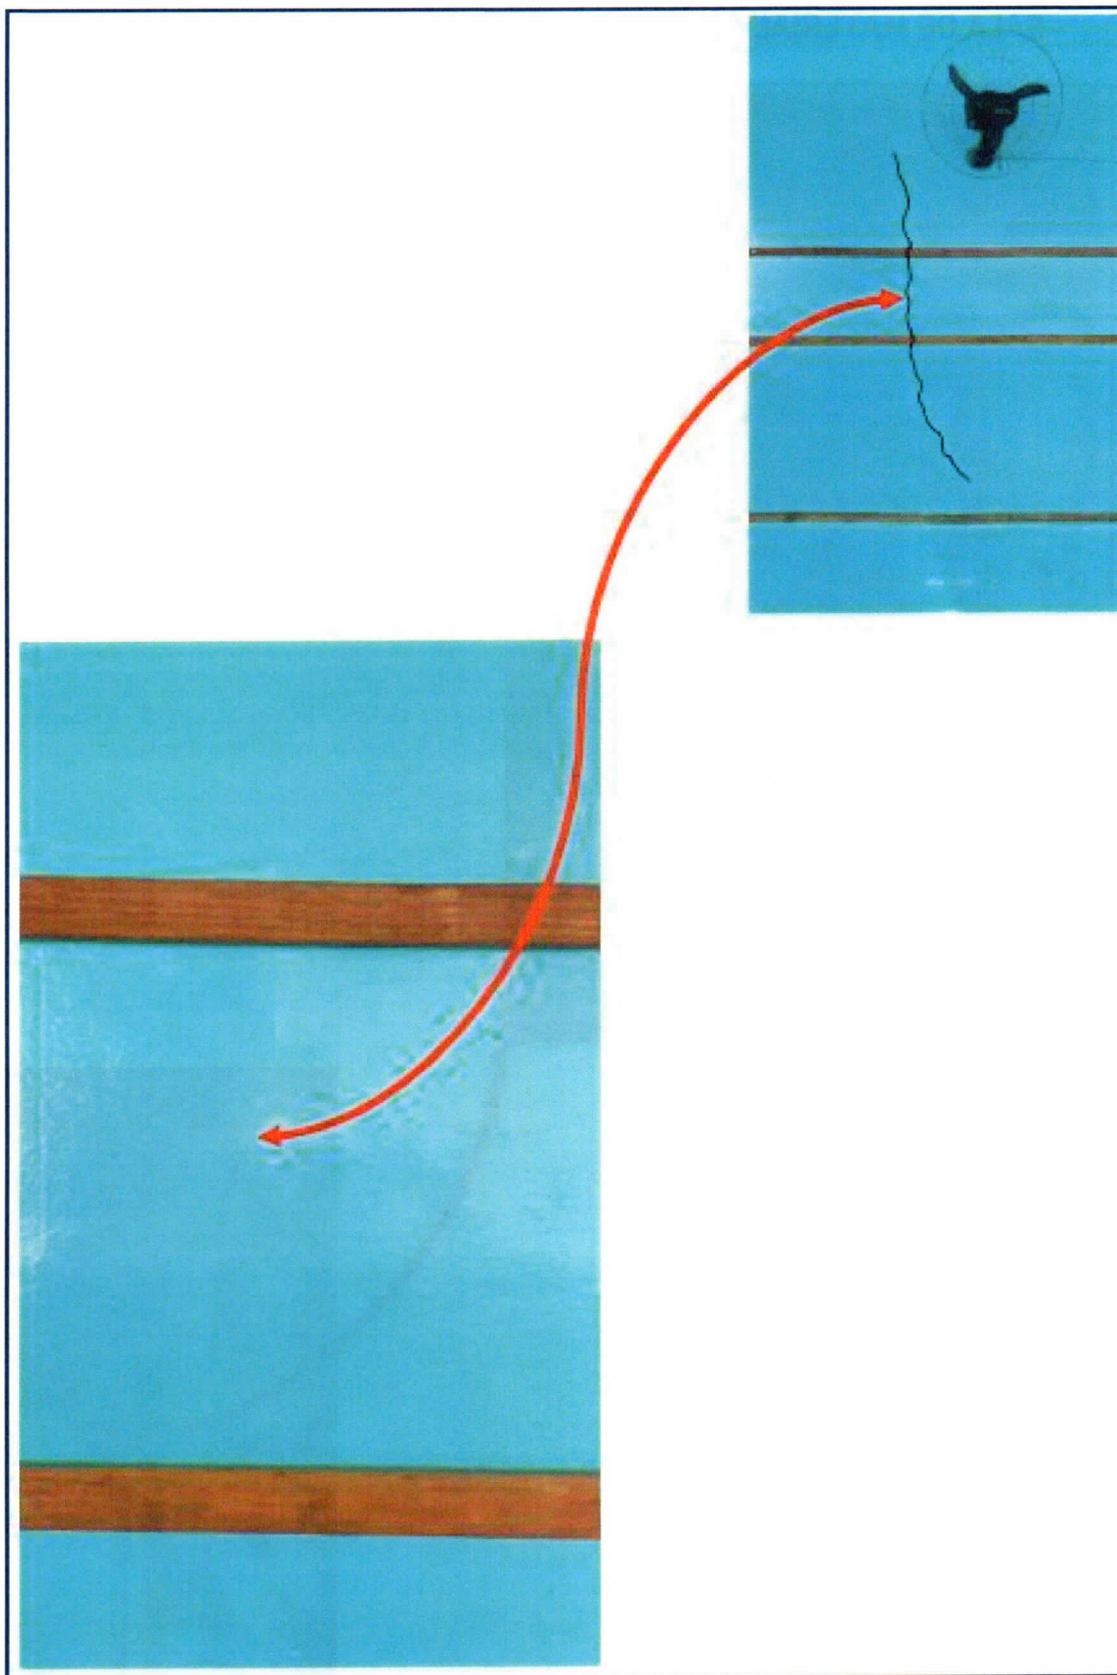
Vista da parede de alvenaria do fundo da sala, apresentando fissura vertical, decorrente da instalação elétrica de uma tomada nova.
